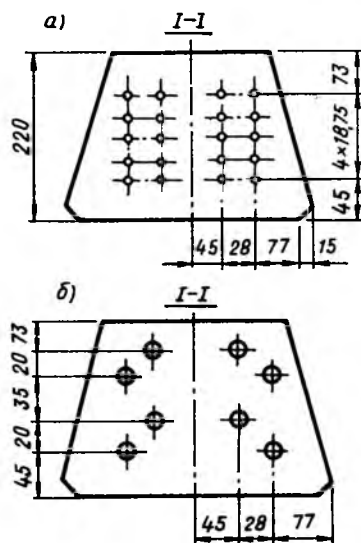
Варианты укрупненного армирования железобетонных шпал а — арматура диаметром 4,5; б — то же 7 мм
